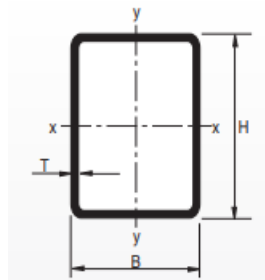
Sección perfil comercial rectangular del Grupo Condesa.
